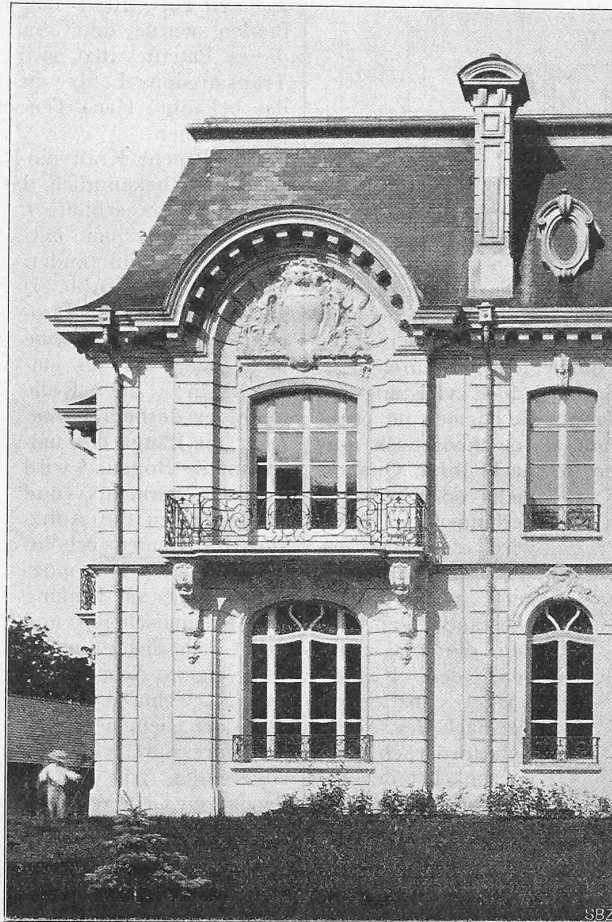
Pavillons d'habitation. — Detail de la façade sud.
